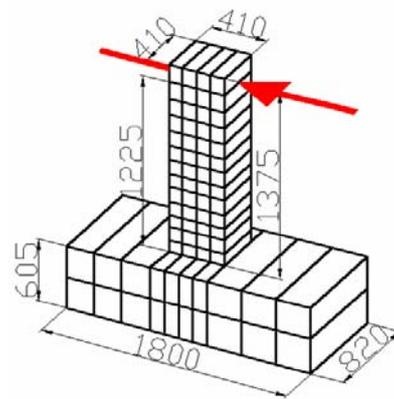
Type1 解析供試体の形状・寸法 (単位: mm)
